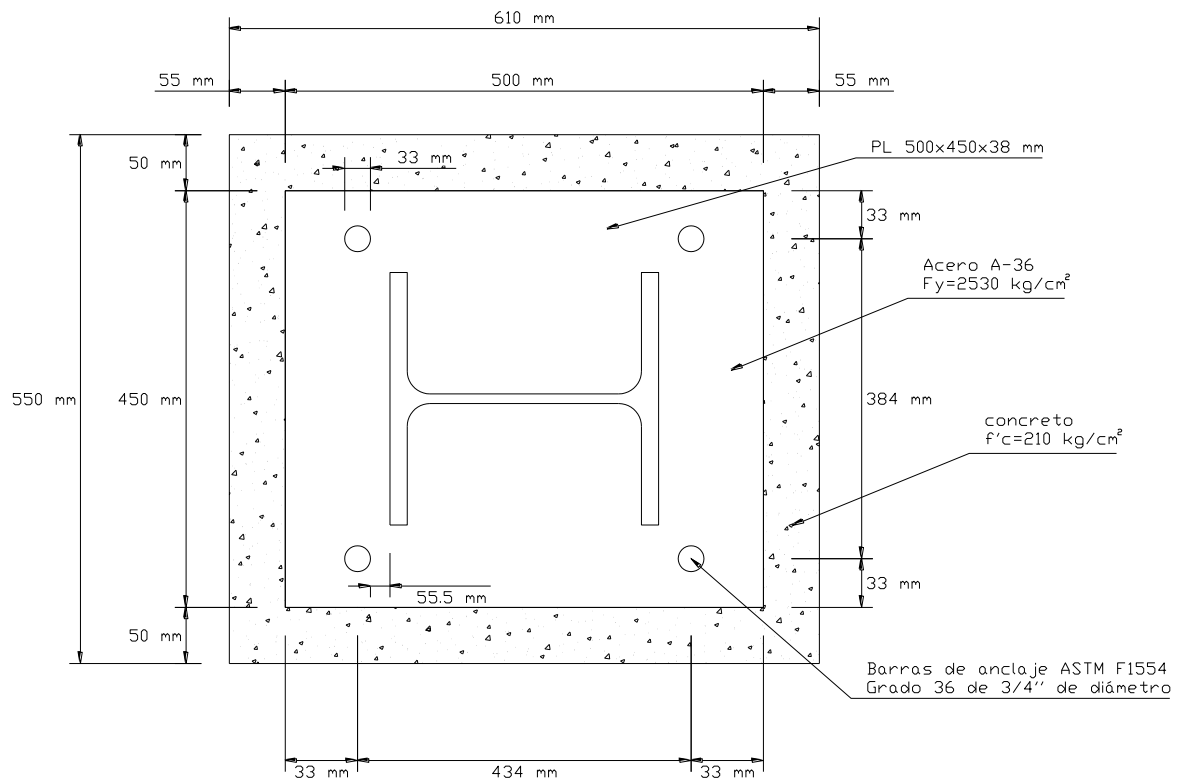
Detallado en Planta del Ejemplo 2.
